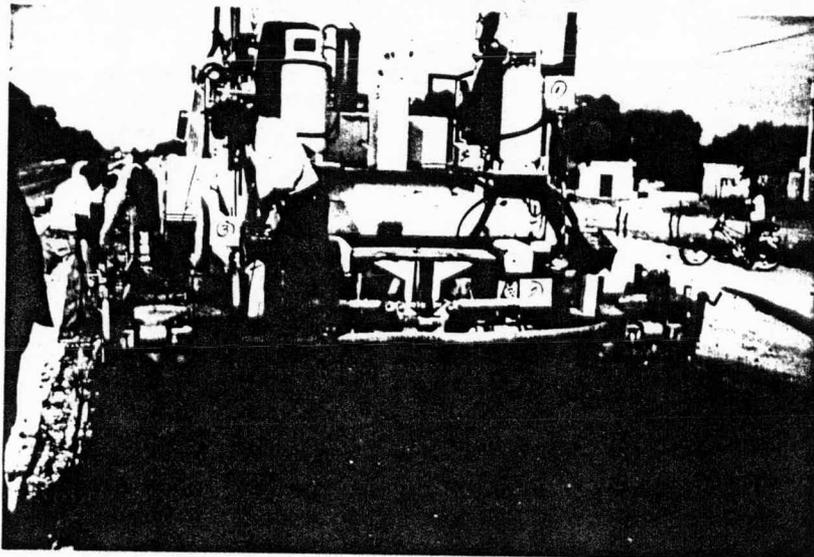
Extendedora realizando trabajos de pavimentación
